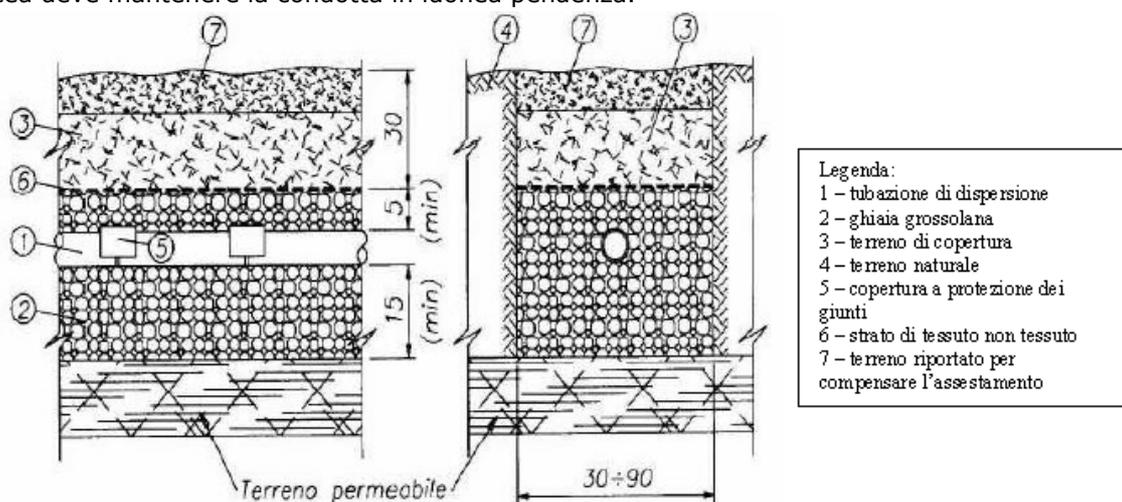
Schema di trincea per la sub-irrigazione nel terreno
